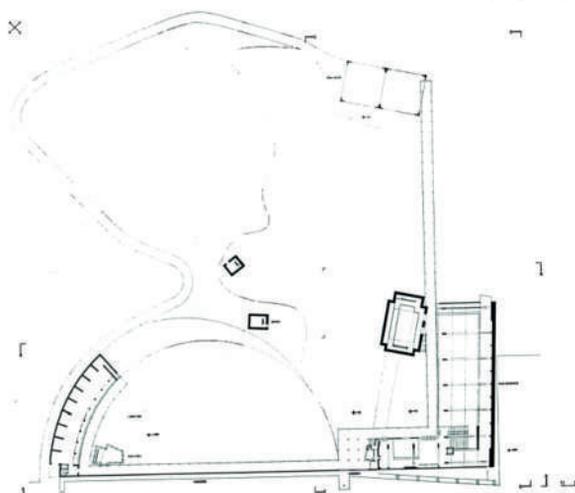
Planimetria generale di progetto a quota m. 4.55
